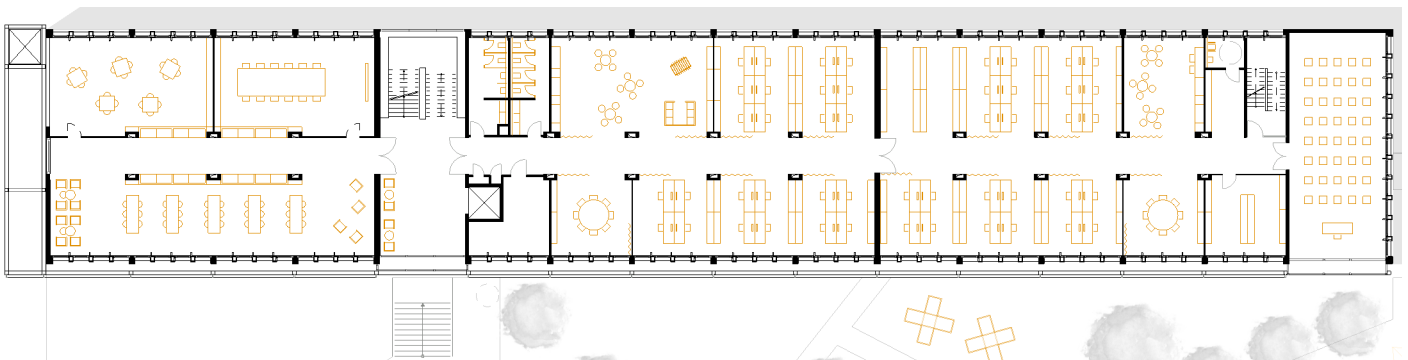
Grundriss 3. Obergeschoss – Bestand 1:500
